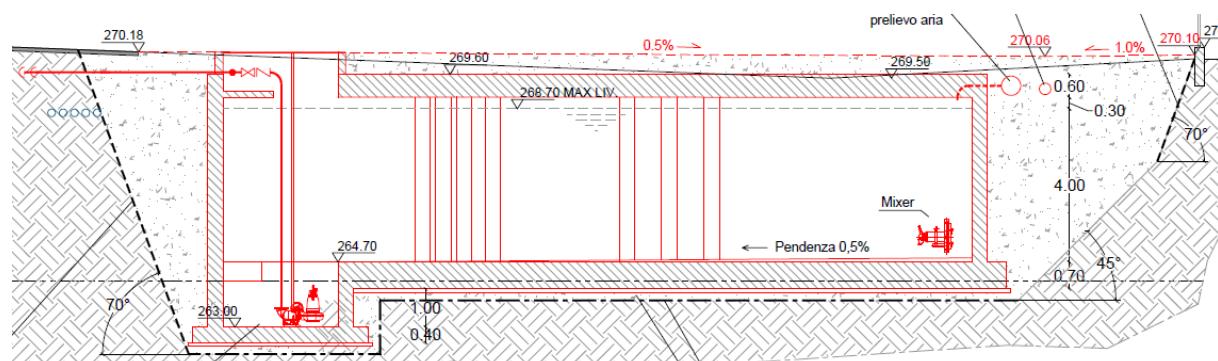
Schnitt A-A Ausgleichbecken / sezione A-A vasca omogenizzazione
